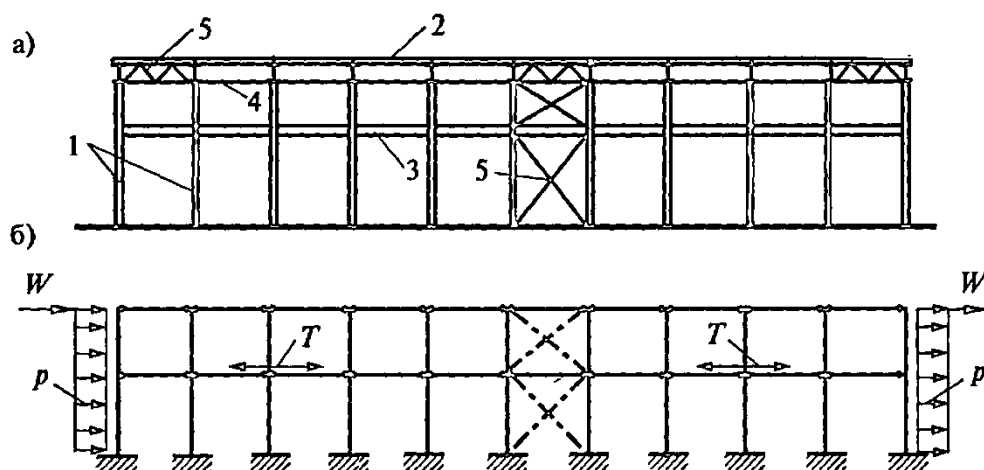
Продольная рама: а) конструктивная схема; б) расчетная схема продольной рамы; 1 — колонна; 2 — плита покрытия; 3 — подкрановая балка; 4 — распорки; 5 — вертикальные связи
